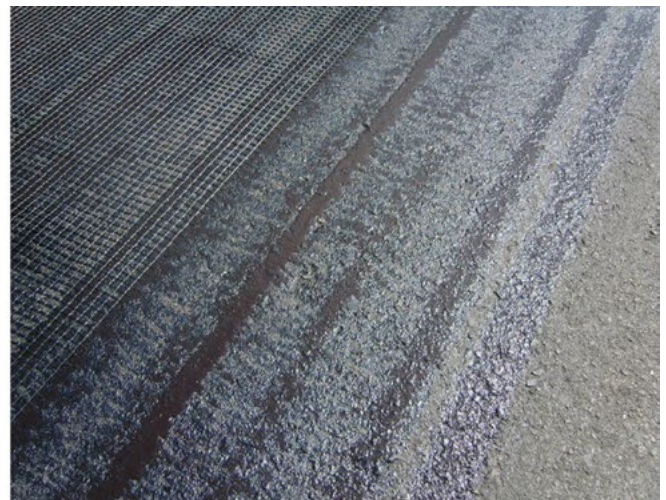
Укладка дорожной сетки между слоями асфальтобетонного покрытия
